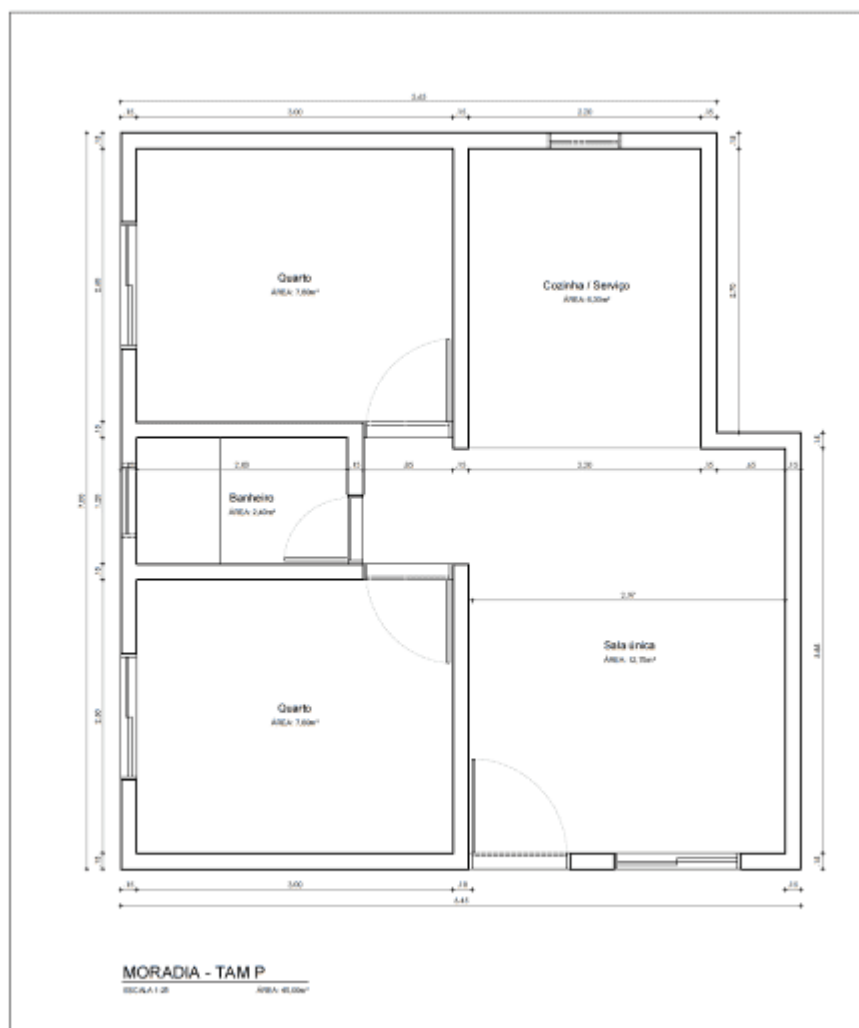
Imagem da planta do apartamento tamanho P (área: 45,00m²) utilizado na oficina.
